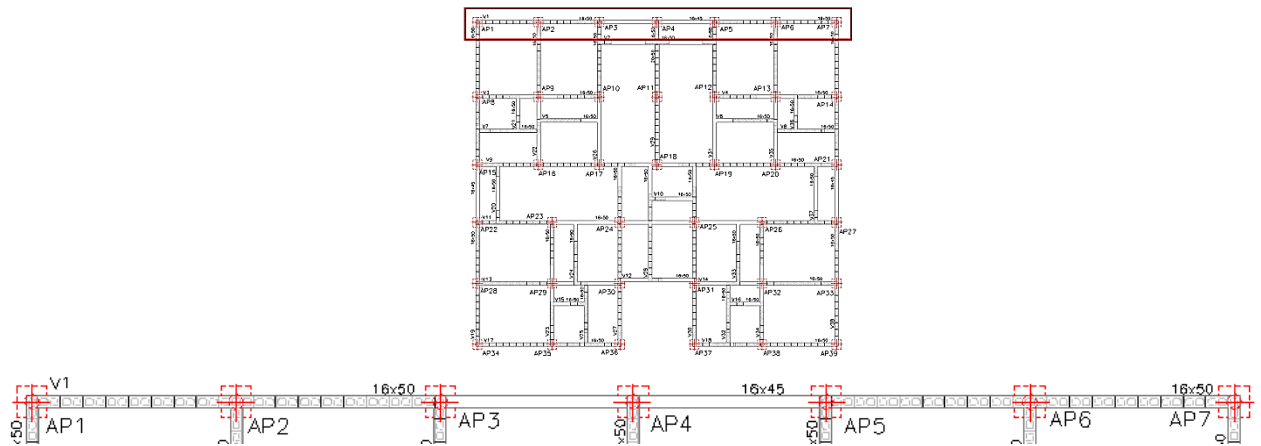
Edifício Vitória Jundiá: localização da viga V1
